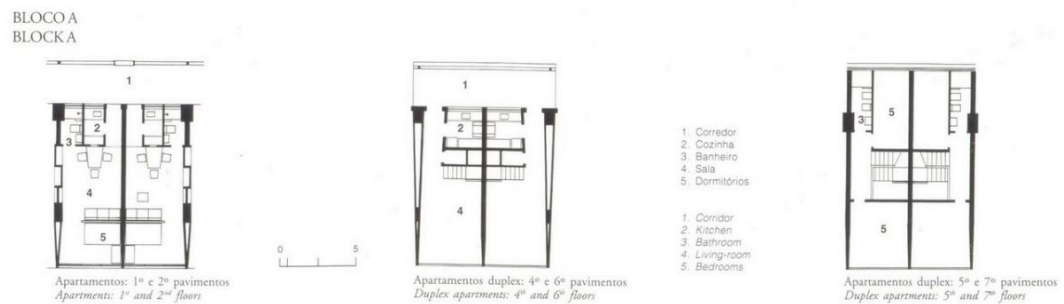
Conjunto Pedregulho: Planta baixa dos apartamentos do bloco A. Fonte: padois
